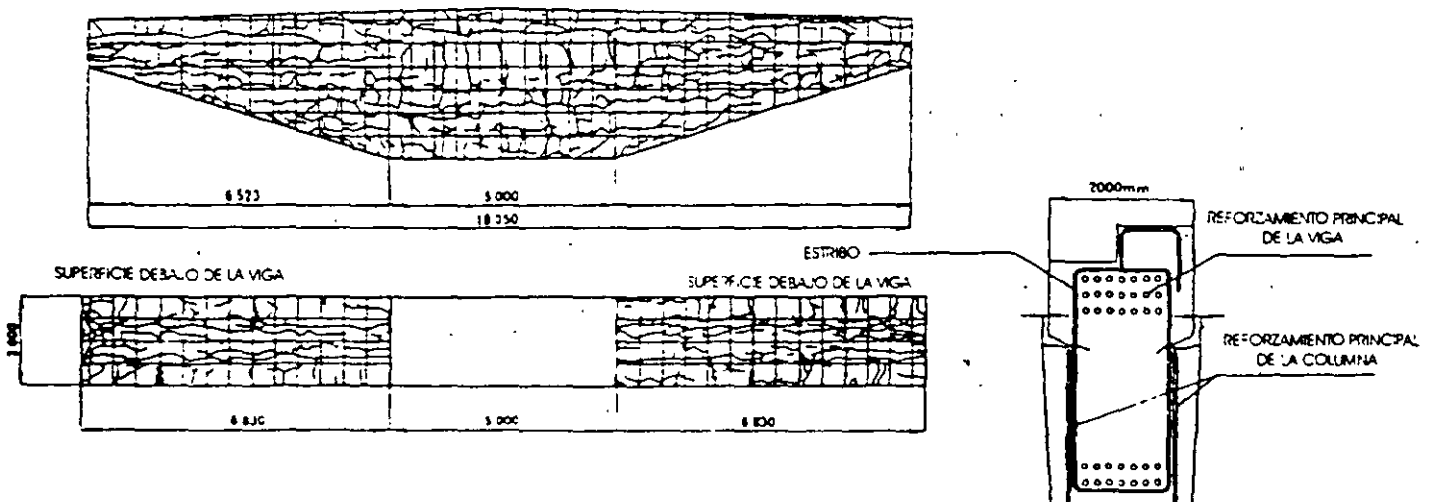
AGRIETAMIENTO DEL CABEZAL DE UNA PILA DE CONCRETO
